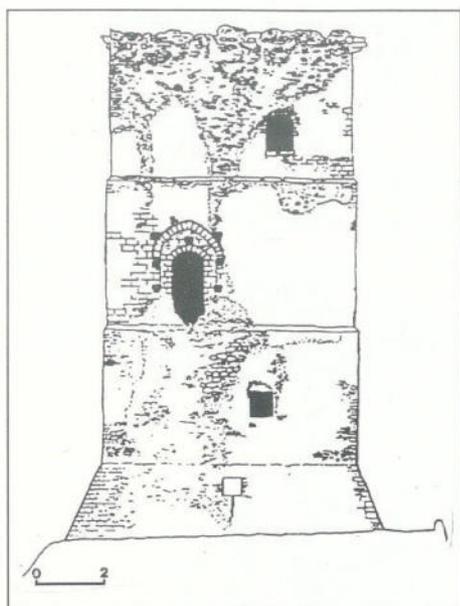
Prospetto S (da MAZZARELLA e ZANCA).
